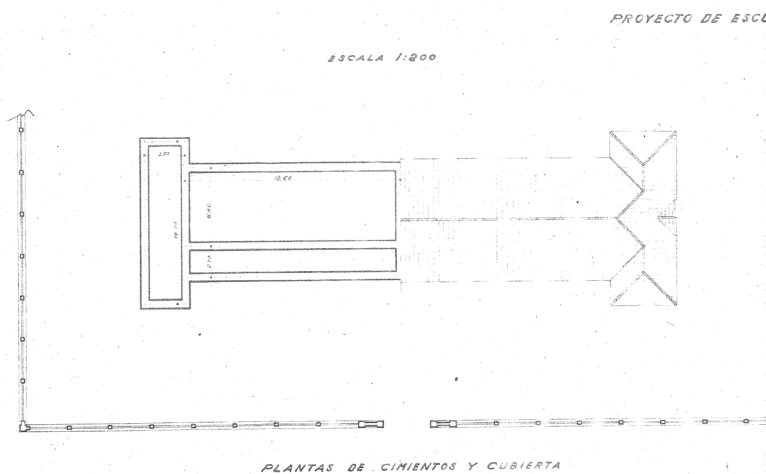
Plano de "Reconstrucción y Reforma". Plantas de Cimientos y Cubiertas Proyecto de Construcción de Escuelas para Medellín (Badajoz)
